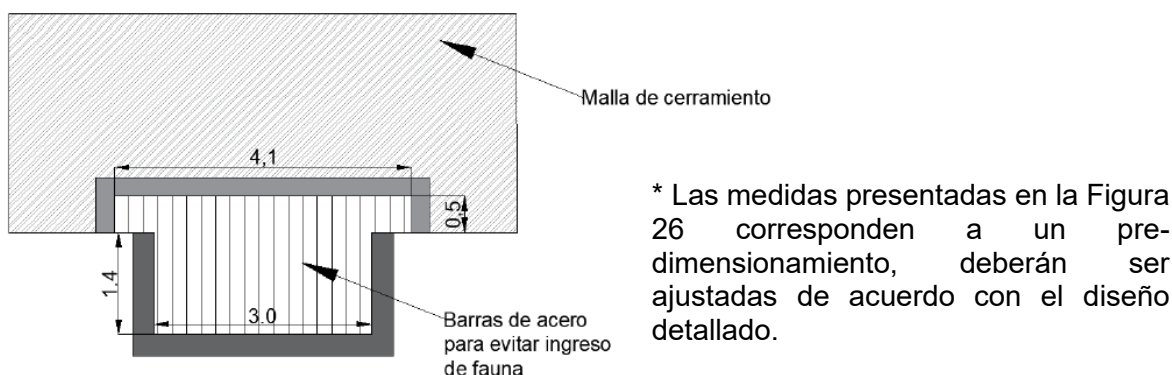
Solución Obra 5 – Ampliación sección hidráulica y modificación del muro cerramiento.
